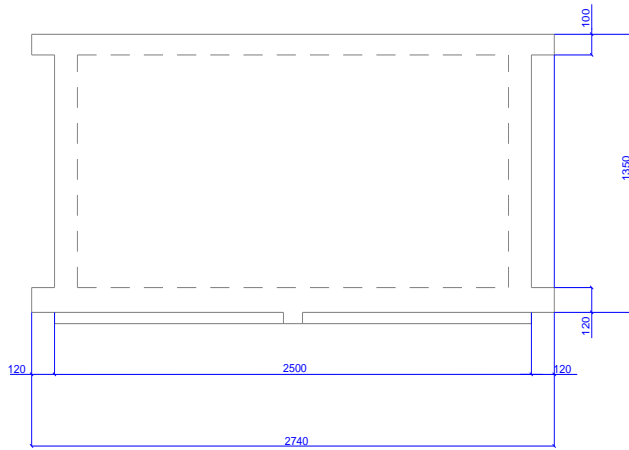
Сходовая площадка 2ЛПФ 28.13
